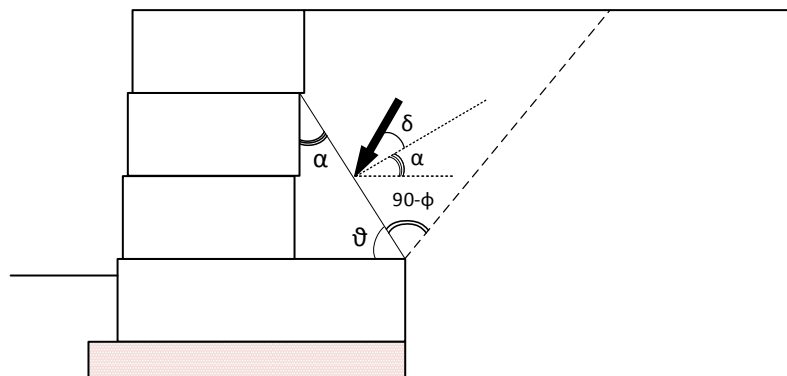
Расчетная схема к определению давления на консольных участках стены
